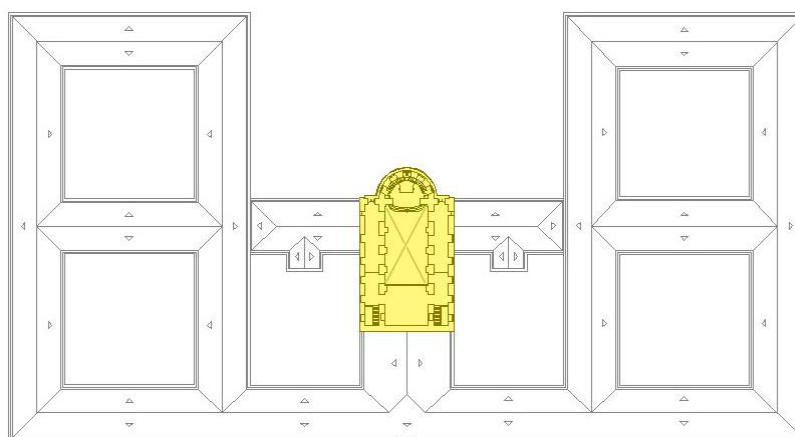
Planta do 3º pavimento (Levantamento 1993) A parte da construção marcada de amarelo constitui o volume construído em 1852. Fonte: Hoirisch, 2007.
